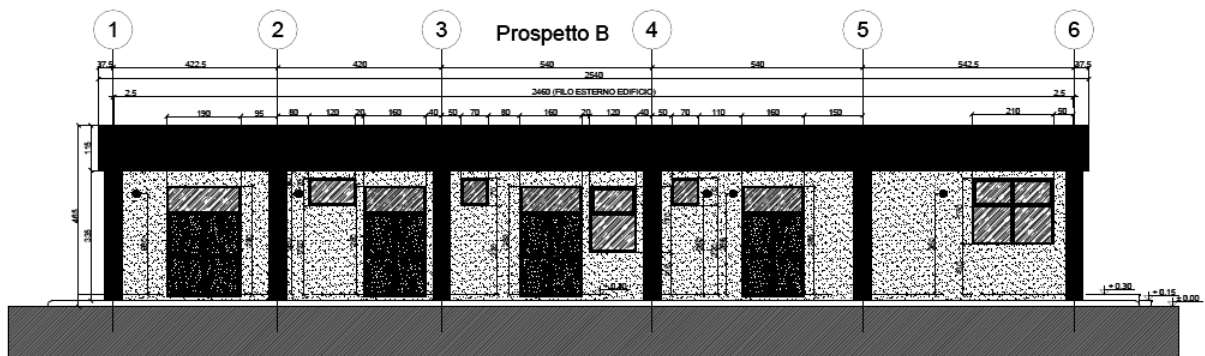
Prospetto edificio comandi della Stazione Elettrica 150 kV
